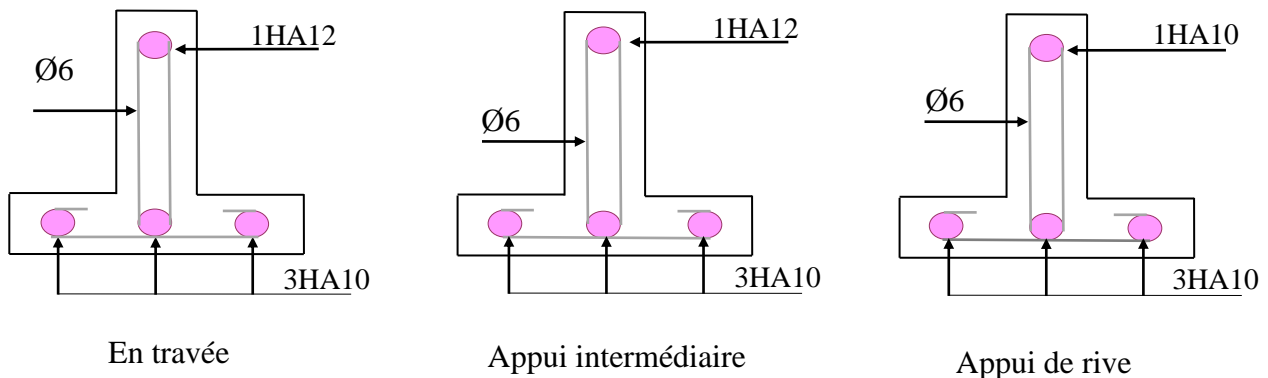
Schéma de Ferrailage des poutrelles plancher étage (Type2).
